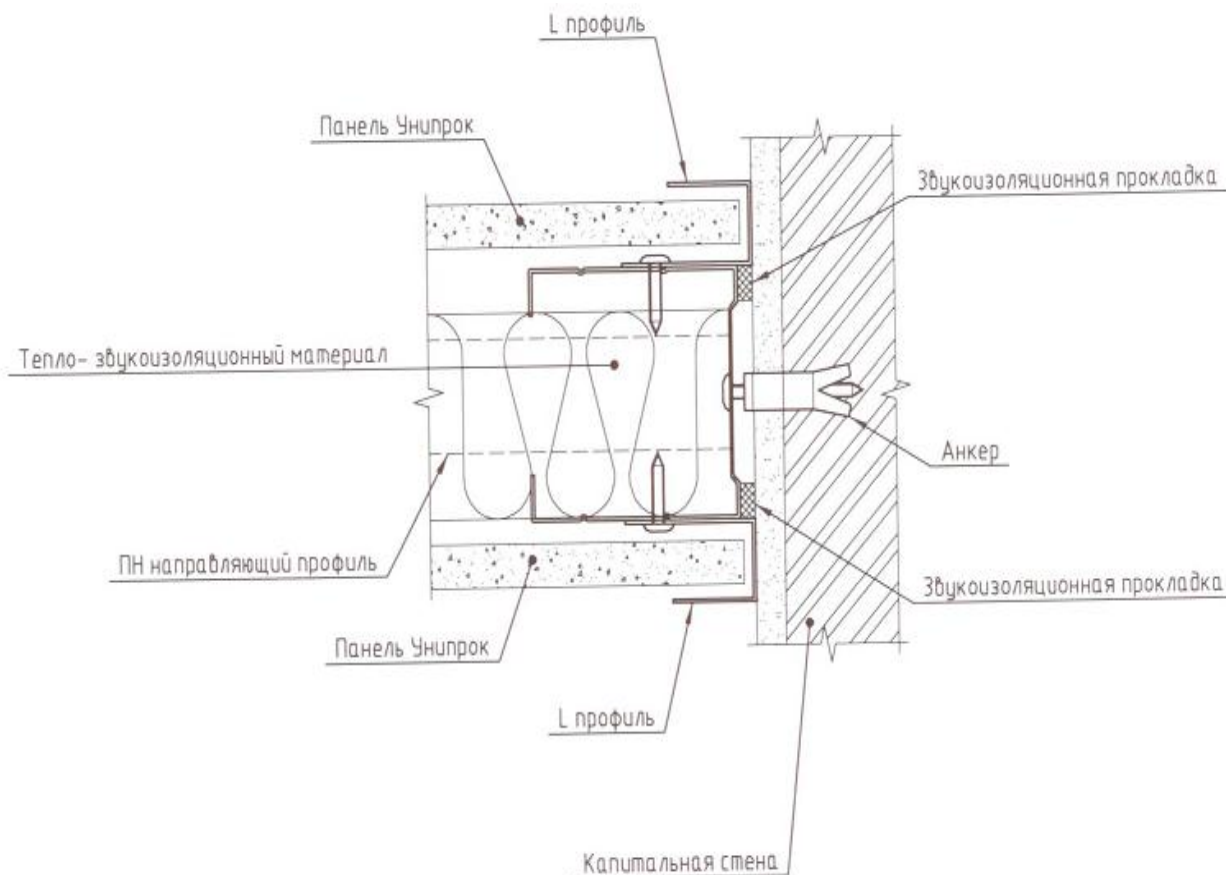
Схема примыкания перегородки с использованием панелей к основанию стены
